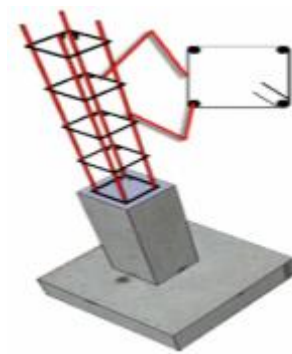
poteau béton armé. Source : abc-maçonnerie.com
